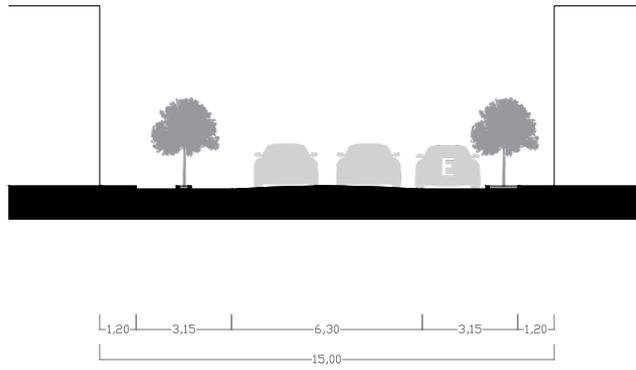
Master plan del diseño de calles. Fuente: Elaboración propia.
